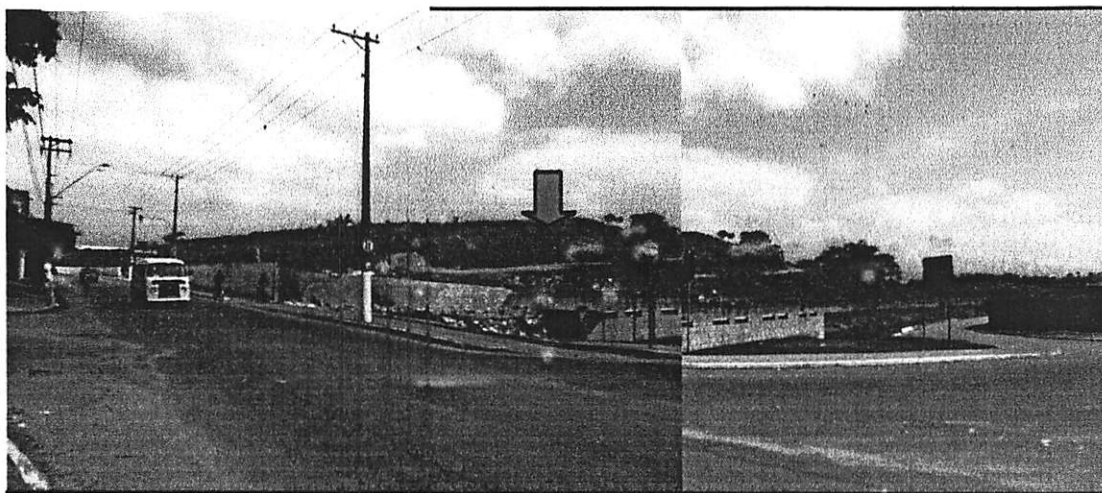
Observador na Av. do Trabalhador com vista para o aterro sanitário do "Lixão" onde se situa os lotes em estudos
